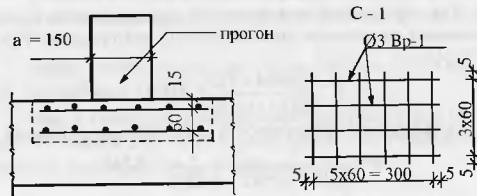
Схема расположения сеток косвенного армирования для расчета на местное смятие, к примеру 5.5
